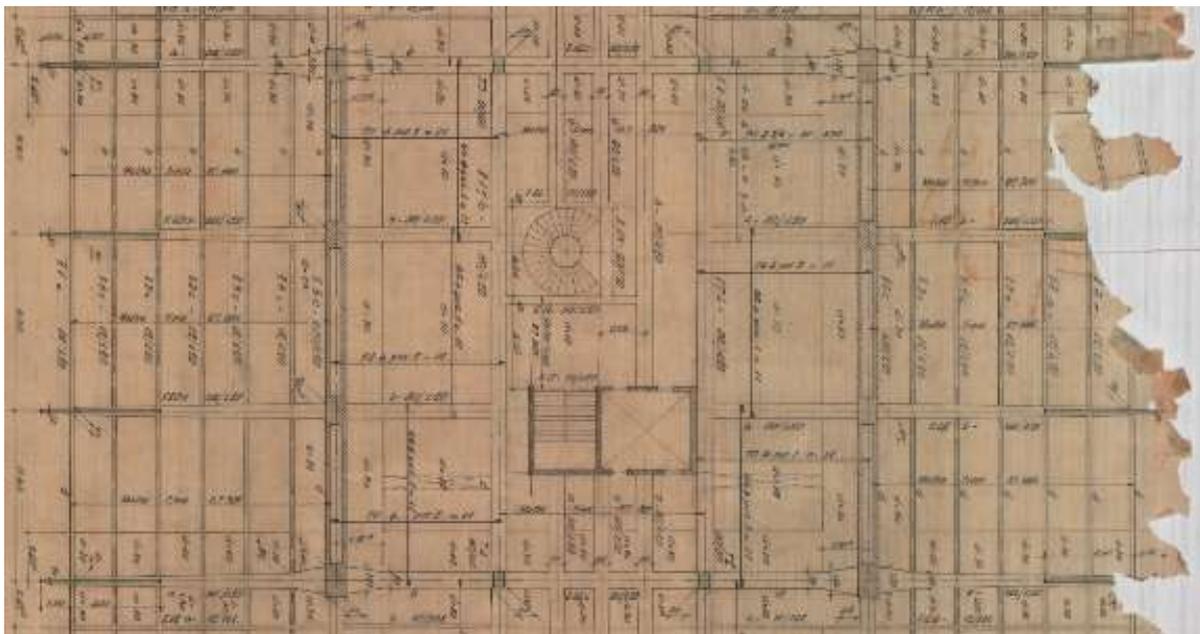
Detalhamento da armação dos pilares de Ernesto Guilherme Walter.
